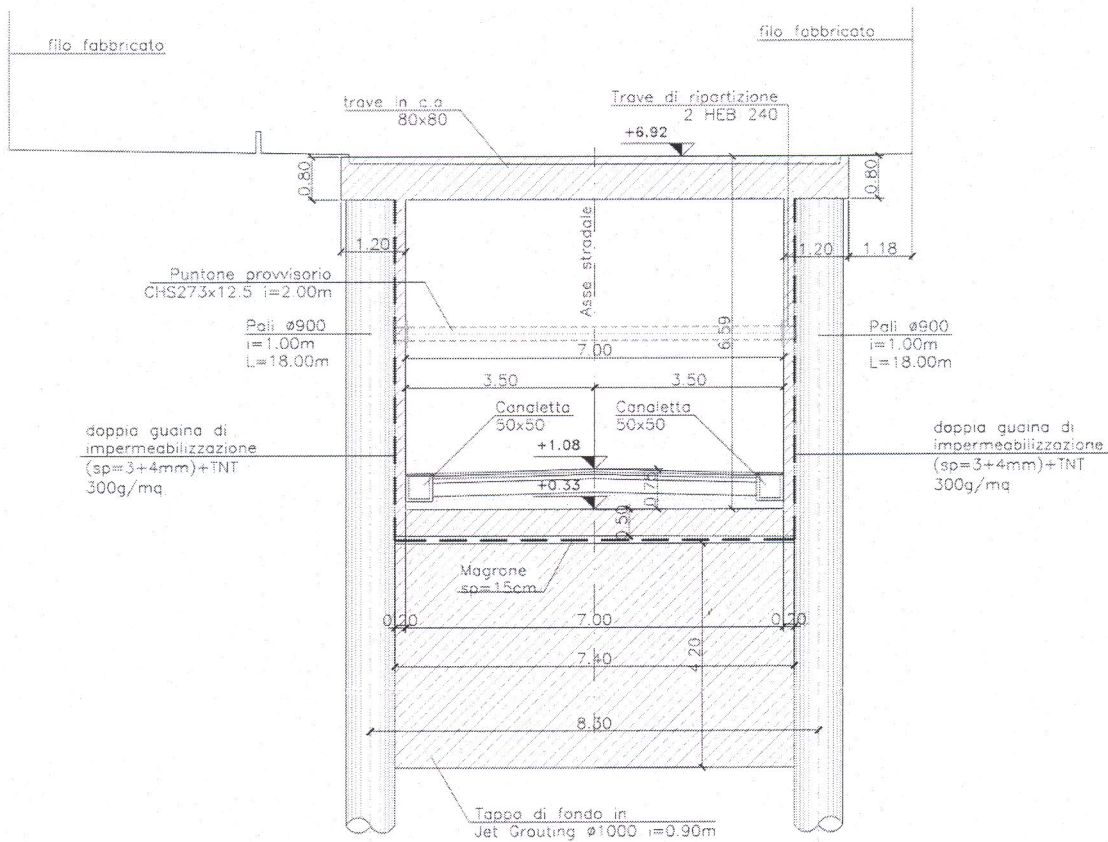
Sezione trasversale tra pk 0+154 a pk 0+163
